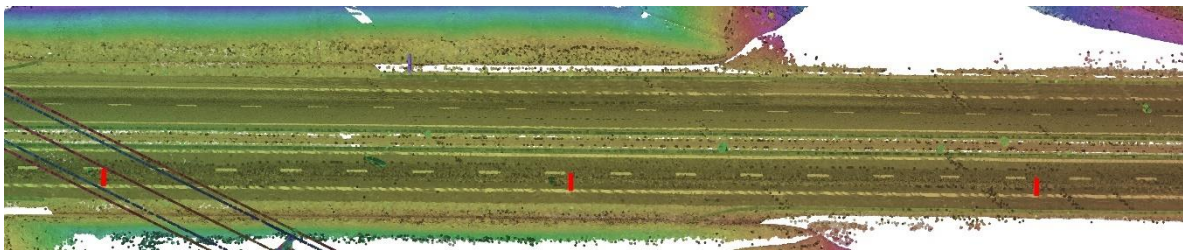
Exemplo da distribuição das linhas transversais ao longo da estrada.
